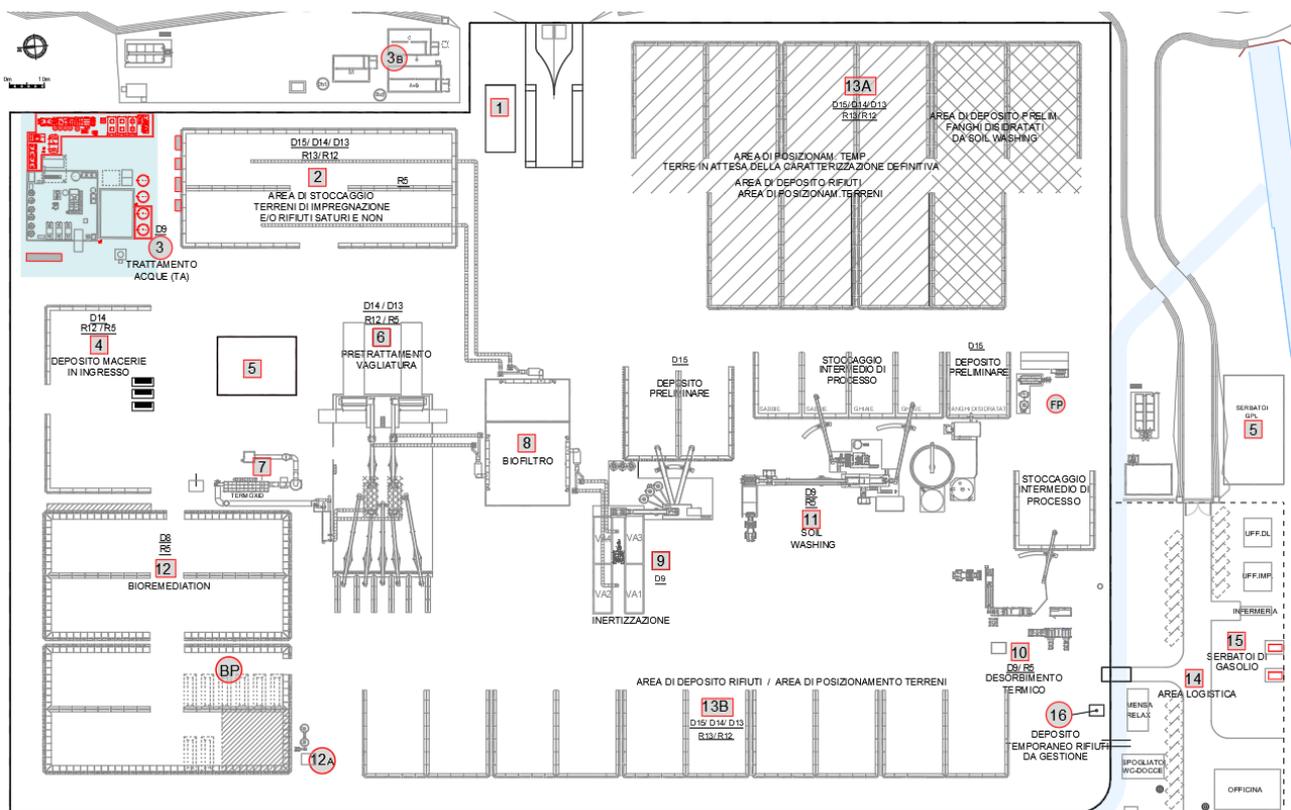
Planimetria Piattaforma Polifunzionale con (in rosso) la linea 2 dell'Impianto TA
